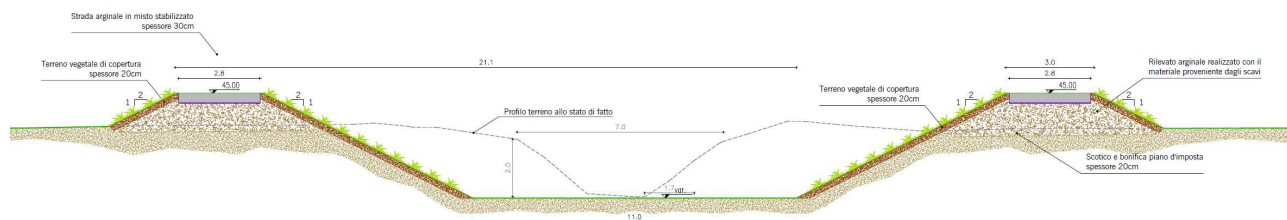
sezione tipo dell'intervento di risezionamento fluviale previsto.
